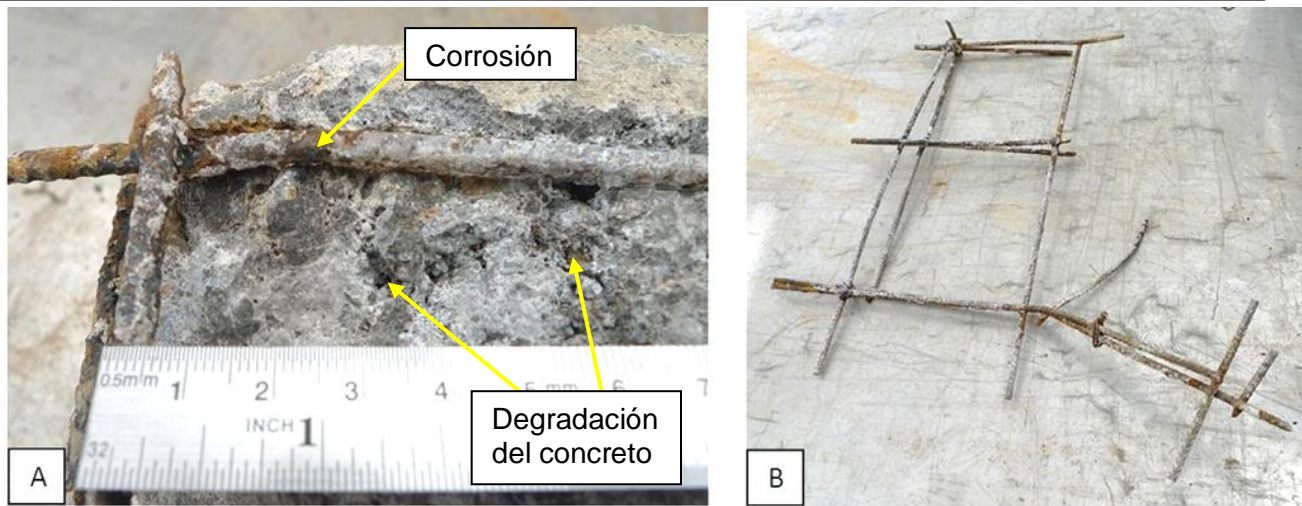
A) Corrosión identificada en el acero de refuerzo del concreto lanzado, km 38+600 RN-27, se observó además pérdida de la matriz cementante del concreto en el interior de la muestra. B) Sección de malla electrosoldada con signos visibles de oxidación y corrosión.
